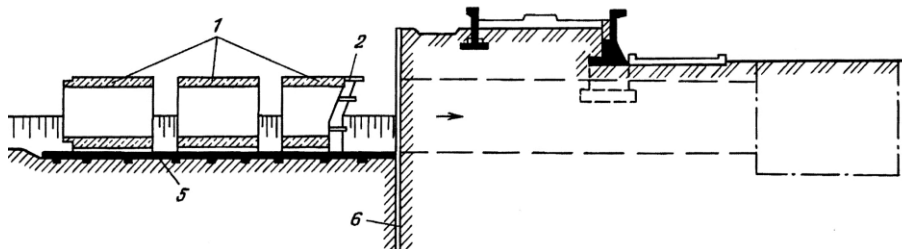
Схема робіт з продавлювання великогабаритних секцій кріплення під автомобільною дорогою: 1 – секція кріплення, 2 – ножева частина; 5 – фундаментна залізобетонна плита; 6 – шпунт
